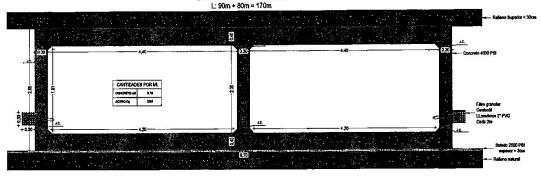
Detalle de la geometría de estructura de entrega pluvial, Box Coulvert de dos cajones, en el Río Guatapurí.
